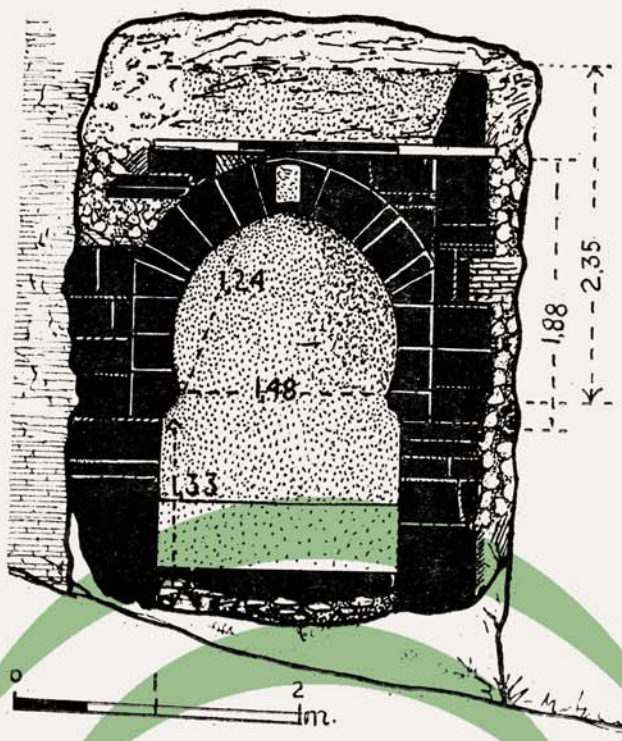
Puerta primitiva de la Alcazaba. Fachada exterior. (Dibujo: B. Pavón.)
